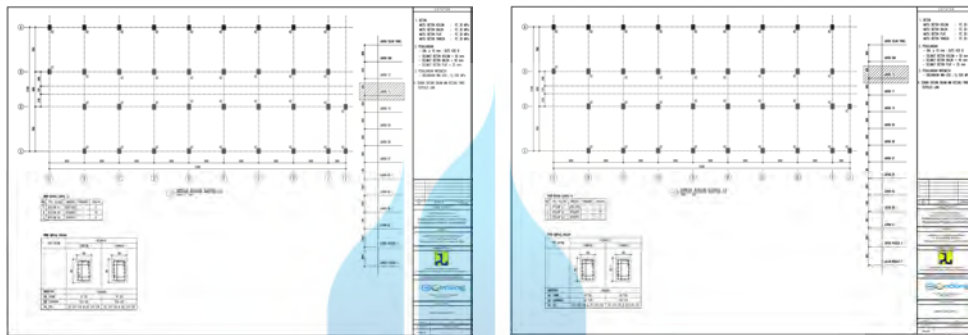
8 Detail struktur kolom lantai 5 dan 6
